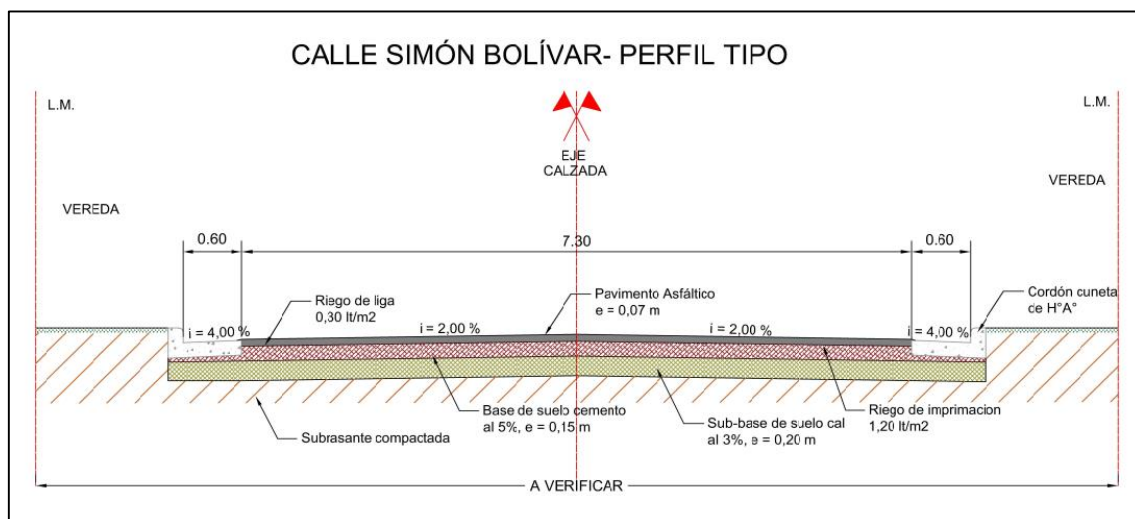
Sección transversal tipo de la calle Simón Bolívar.
